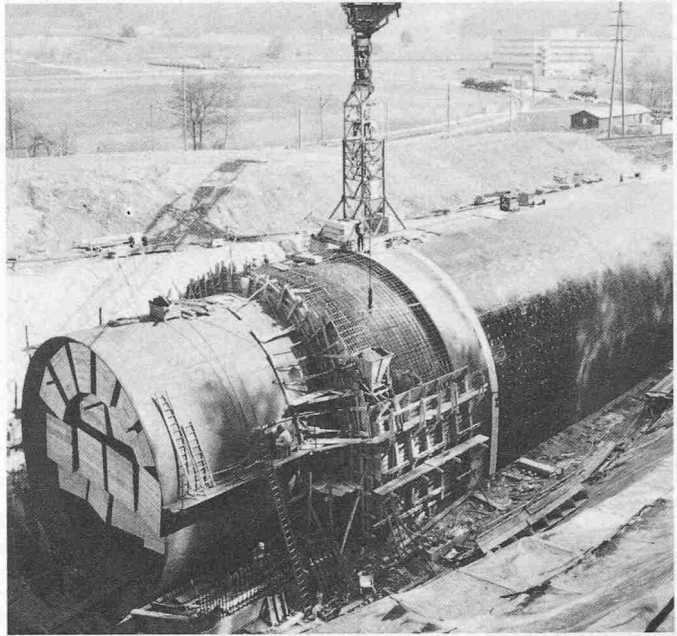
Los Ost. Im Tagbau erstelltes Tunnelstück mit fertig montiertem Vortriebschild und ausgefahrenem Brustverbau
